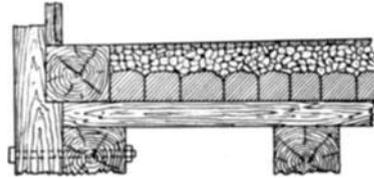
Anbringung eines Schotterbettes mit Packlage auf einer hölzernen Brücke.
